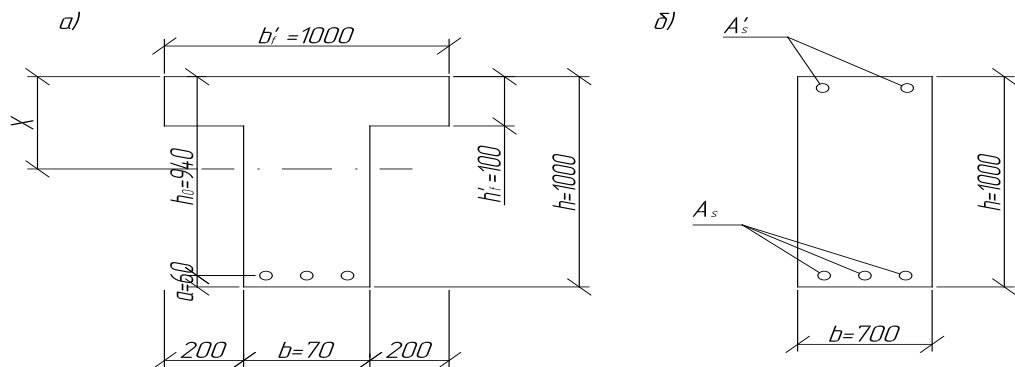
Приведений розрахунковий переріз ригеля: а) в прольоті, б) на опорі
